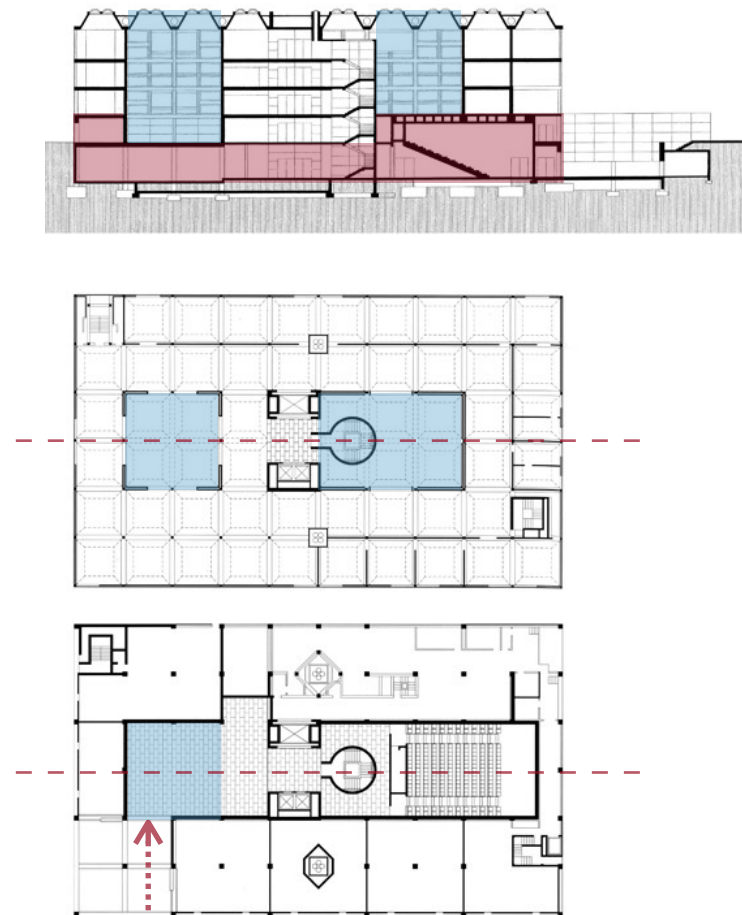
Galería de Arte Británico de Yale. De arriba a abajo: Sección, última planta y planta baja. En azul se representan los patios, en rojo la zona comercial. La fecha indica la entrada y la línea la sección.
